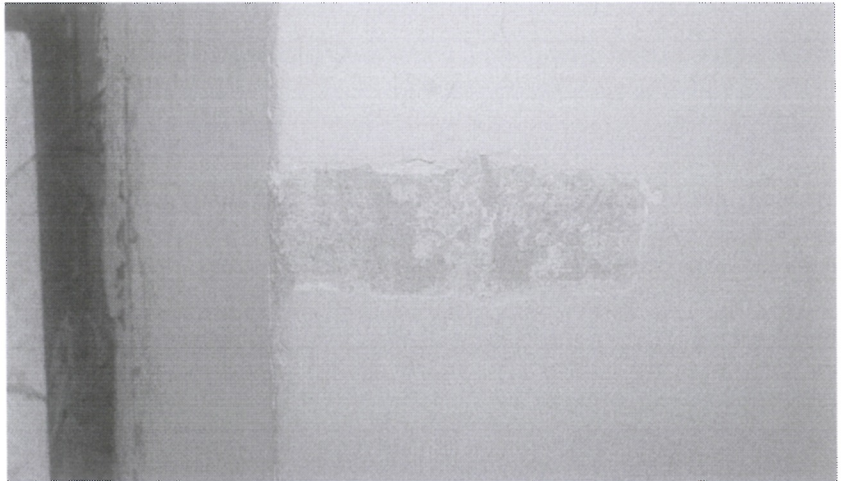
Oryginalny kolor stolarki drzwiowej NCS S 4040-Y10R.
